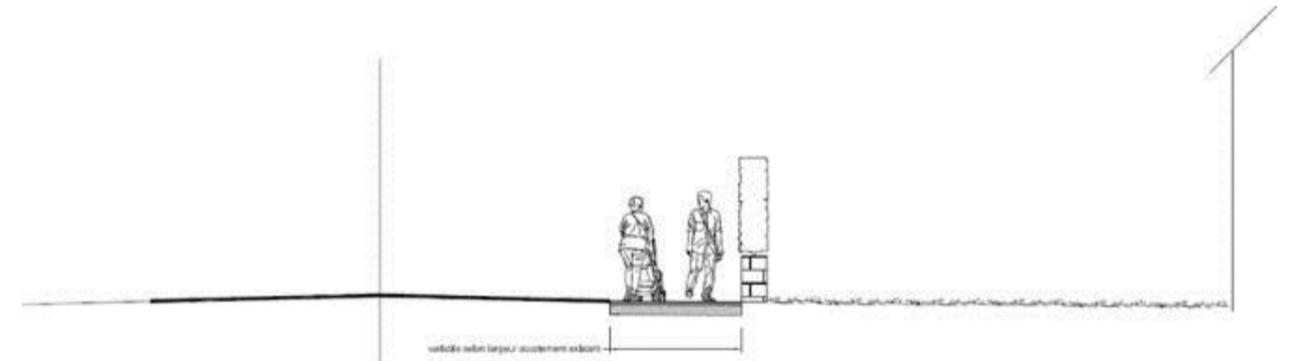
Le profil en travers d'un aménagement en site propre en mitoyenneté d'une route
